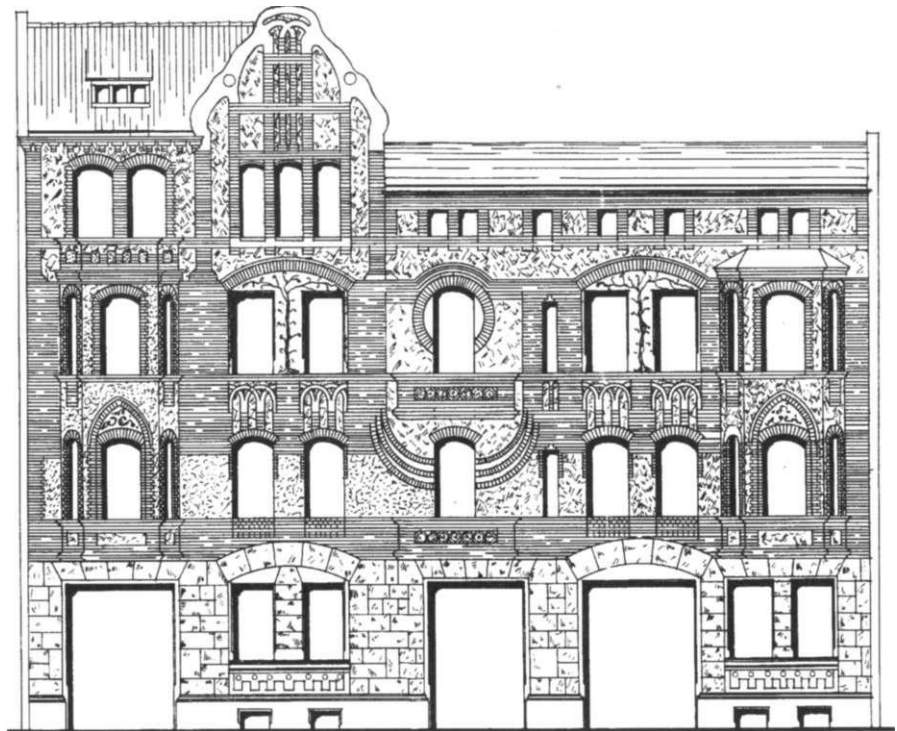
Liebermannstraße 20, Fassadenaufriß
